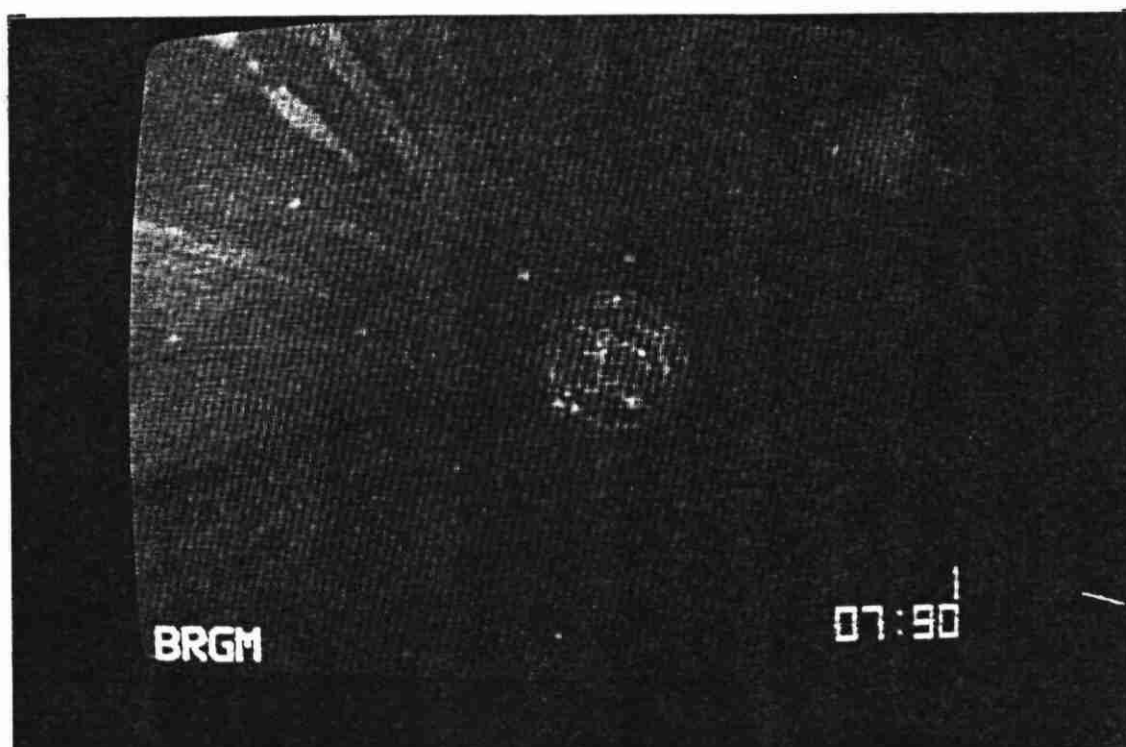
Prof. 115,2 m : Télescopage du tube porte-crépine
